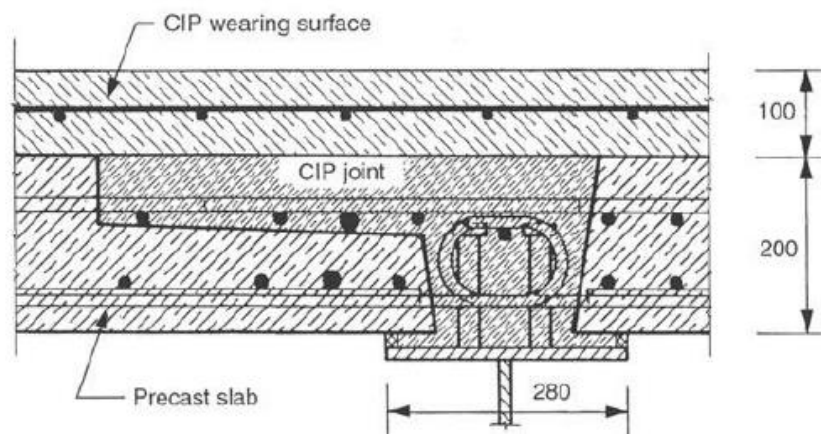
Esquema típico de tablero de sección compuesta, con paneles de concreto prefabricado
